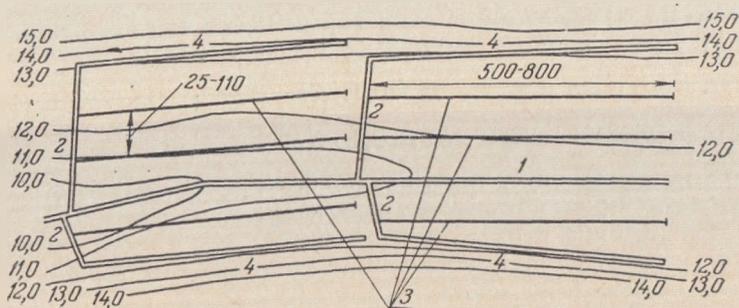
Схема открытой осушительной сети на торфяном болоте:
